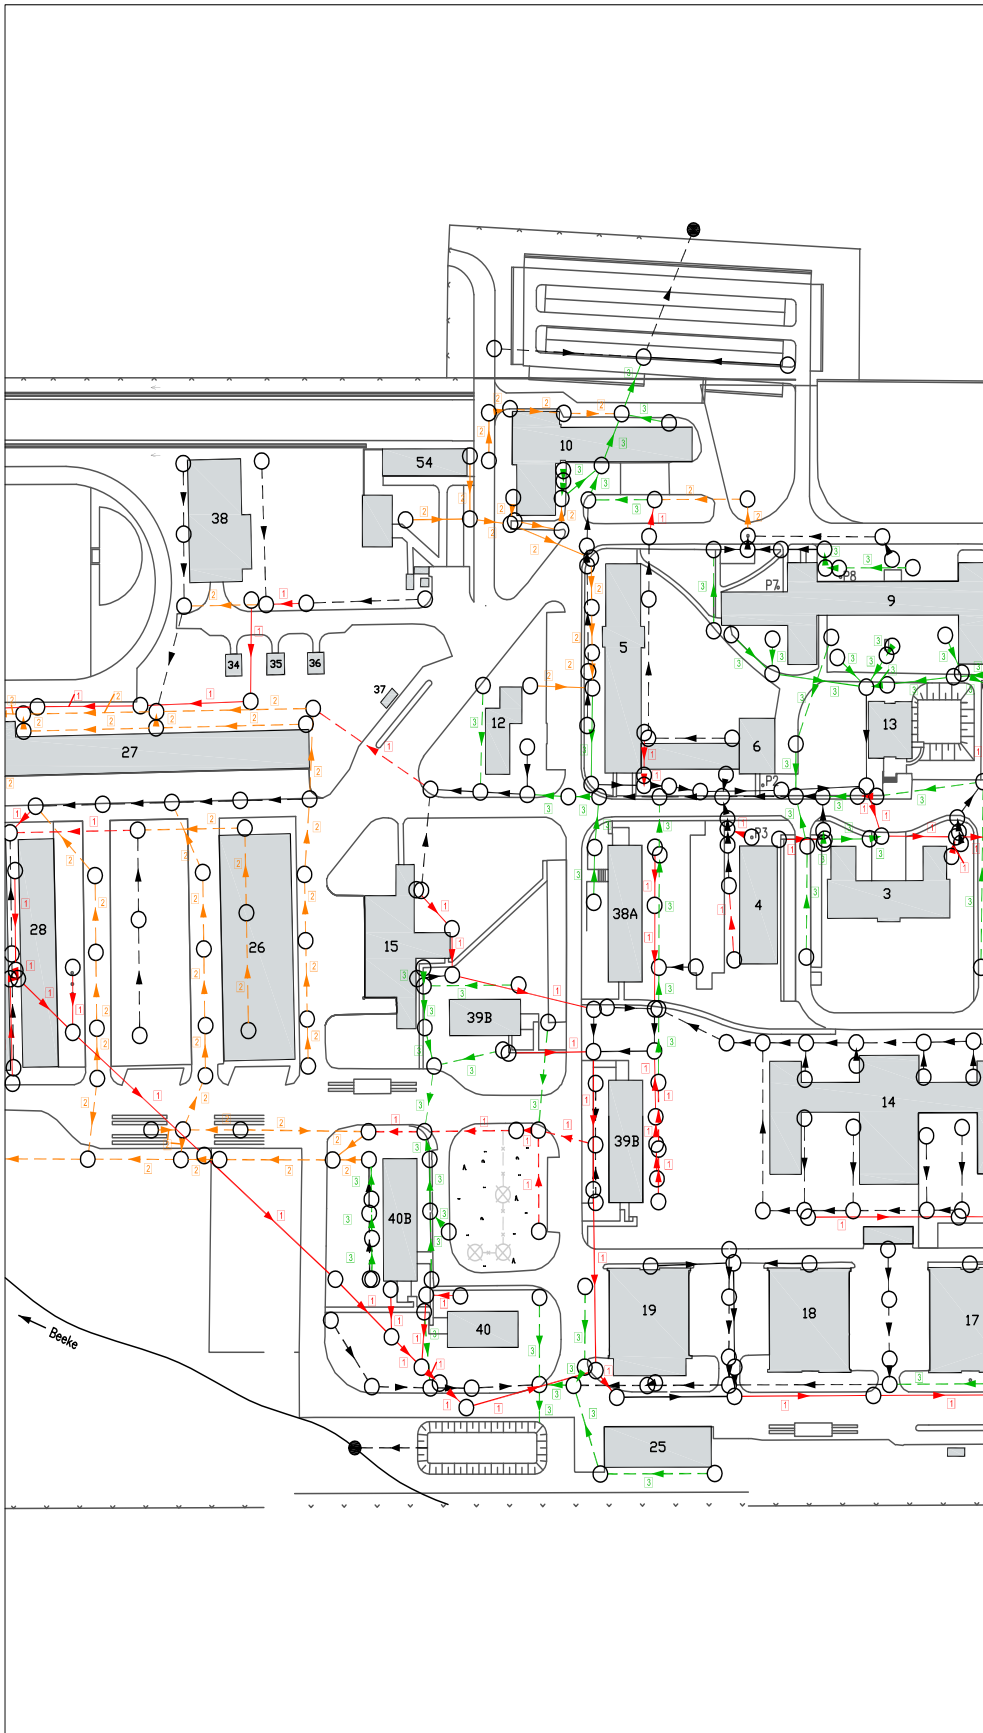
Beispielplan: Übersichtslageplan „Sanierungsabschnitte“
